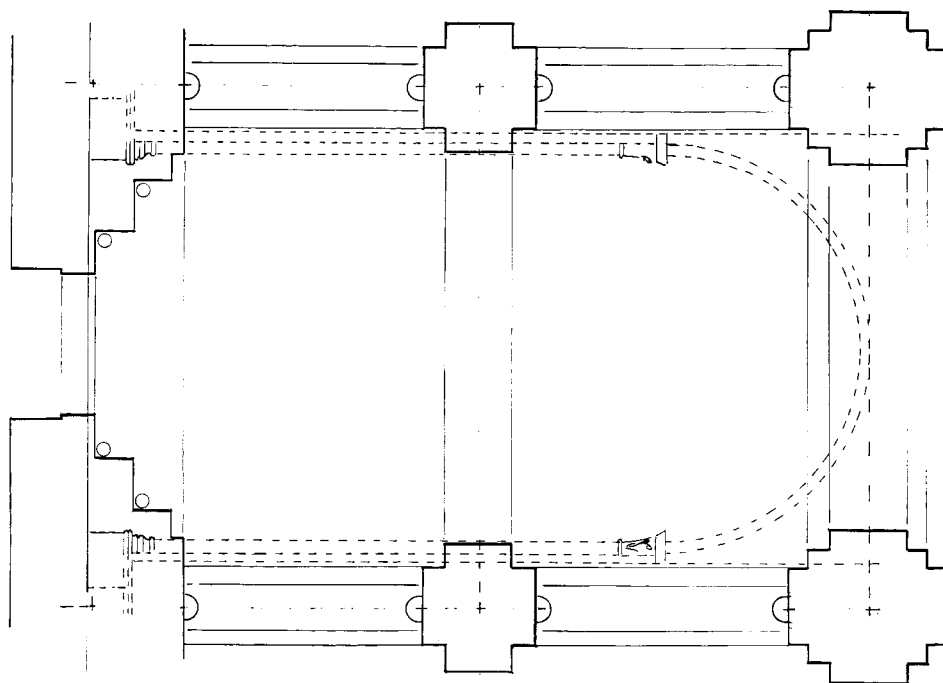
La planta del pórtico superpuesta al arco toral de la nave central de la catedral de Jaca.
